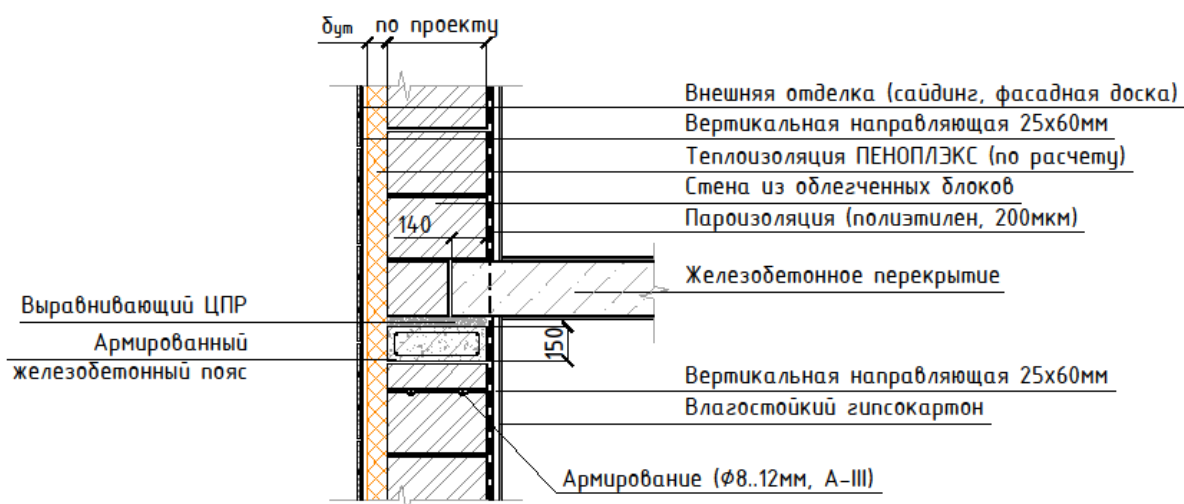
Схема сопряжения стены из керамических блоков с железобетонным перекрытием (плиты ПЕНОПЛЭКС снаружи).
